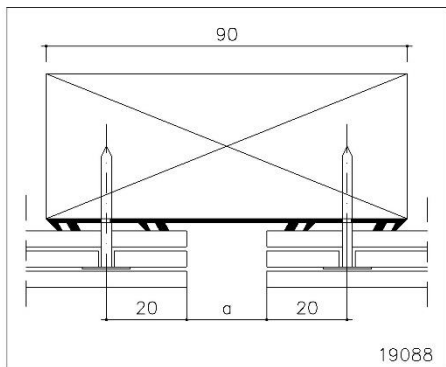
joint de 90 mm en EPDM derrière le joint ouvert
